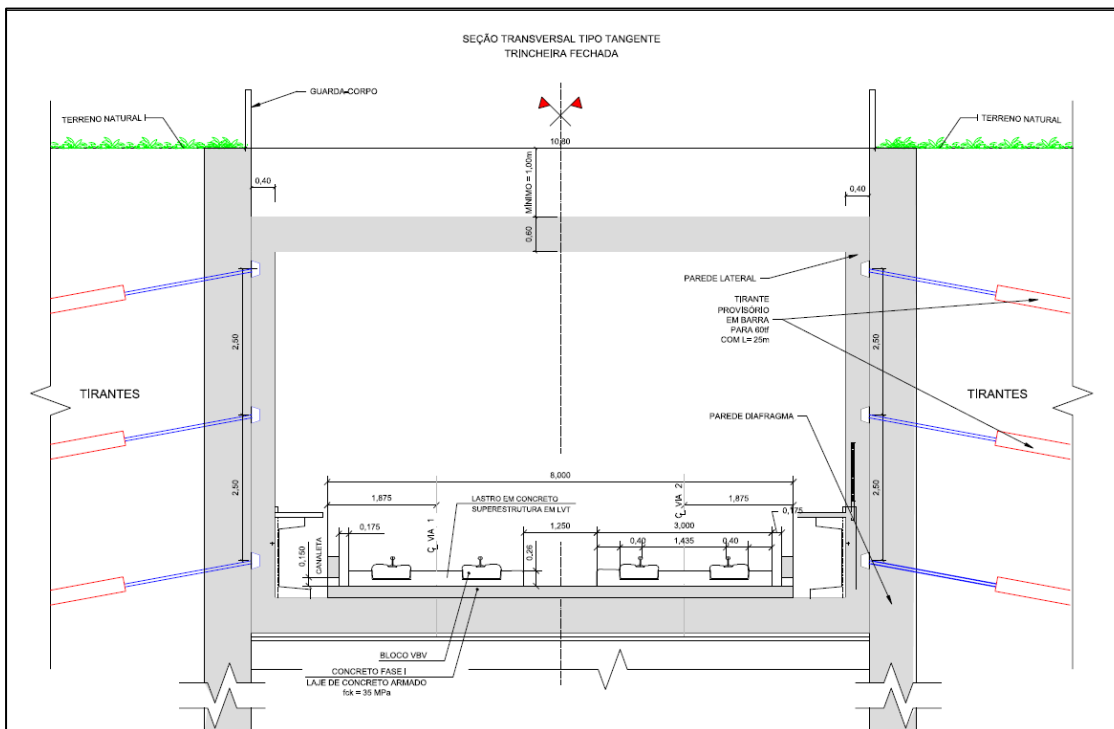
Seção transversal tipo – Detalhe Trecho em Tangente, Trincheira Cut na Cover Superestrutura LVT
